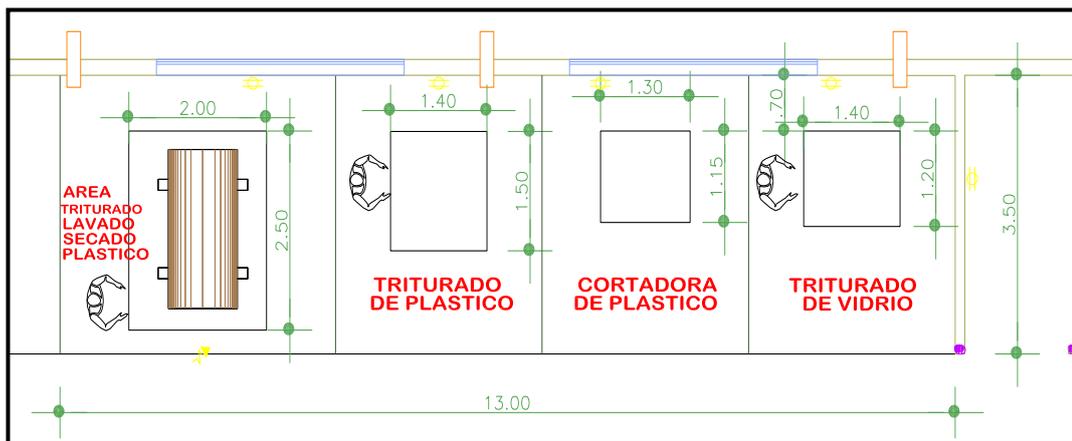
Vista arquitectónica específica del área de triturado, lavado y secado de la planta de reciclaje
